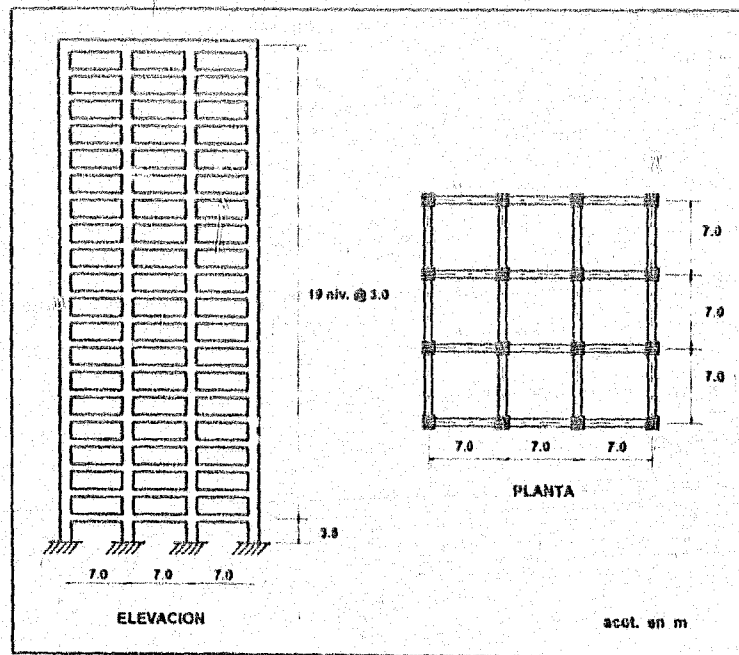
Dimensiones del marco y planta tipo del edificio.
